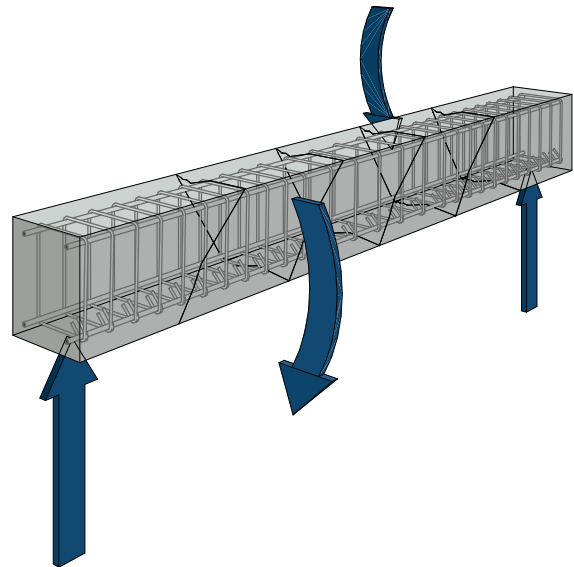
Fisuración por torsión en viga de hormigón armado. (Autores, 2017)
